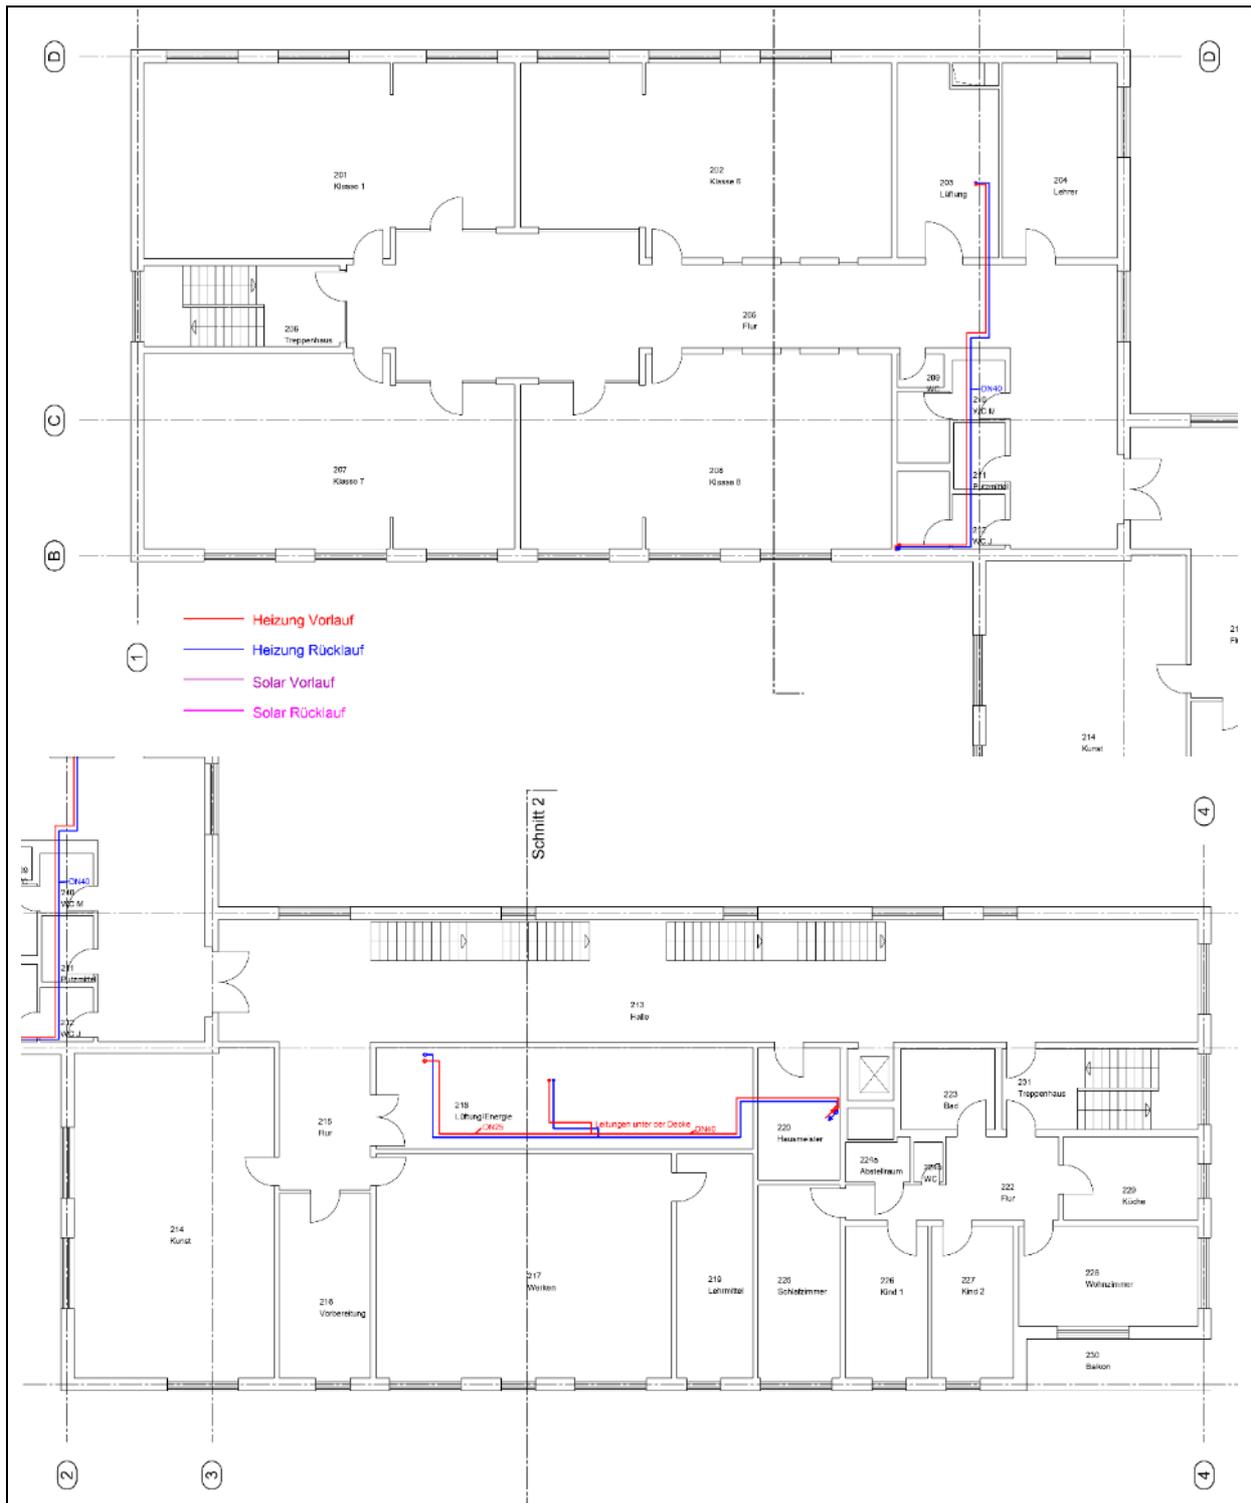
Grundriss Heizung – 2. Obergeschoss – BTA (unten) und BTB (oben) [3]
